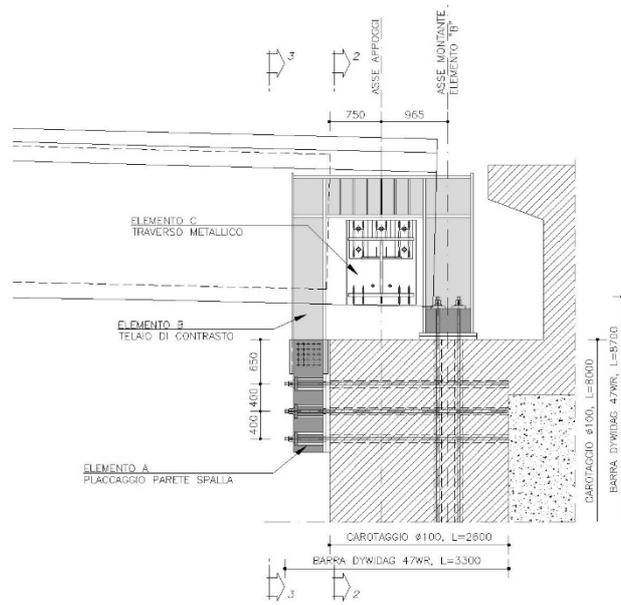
Spalle Sp.2 e Sp.4 - Sezione longitudinale
